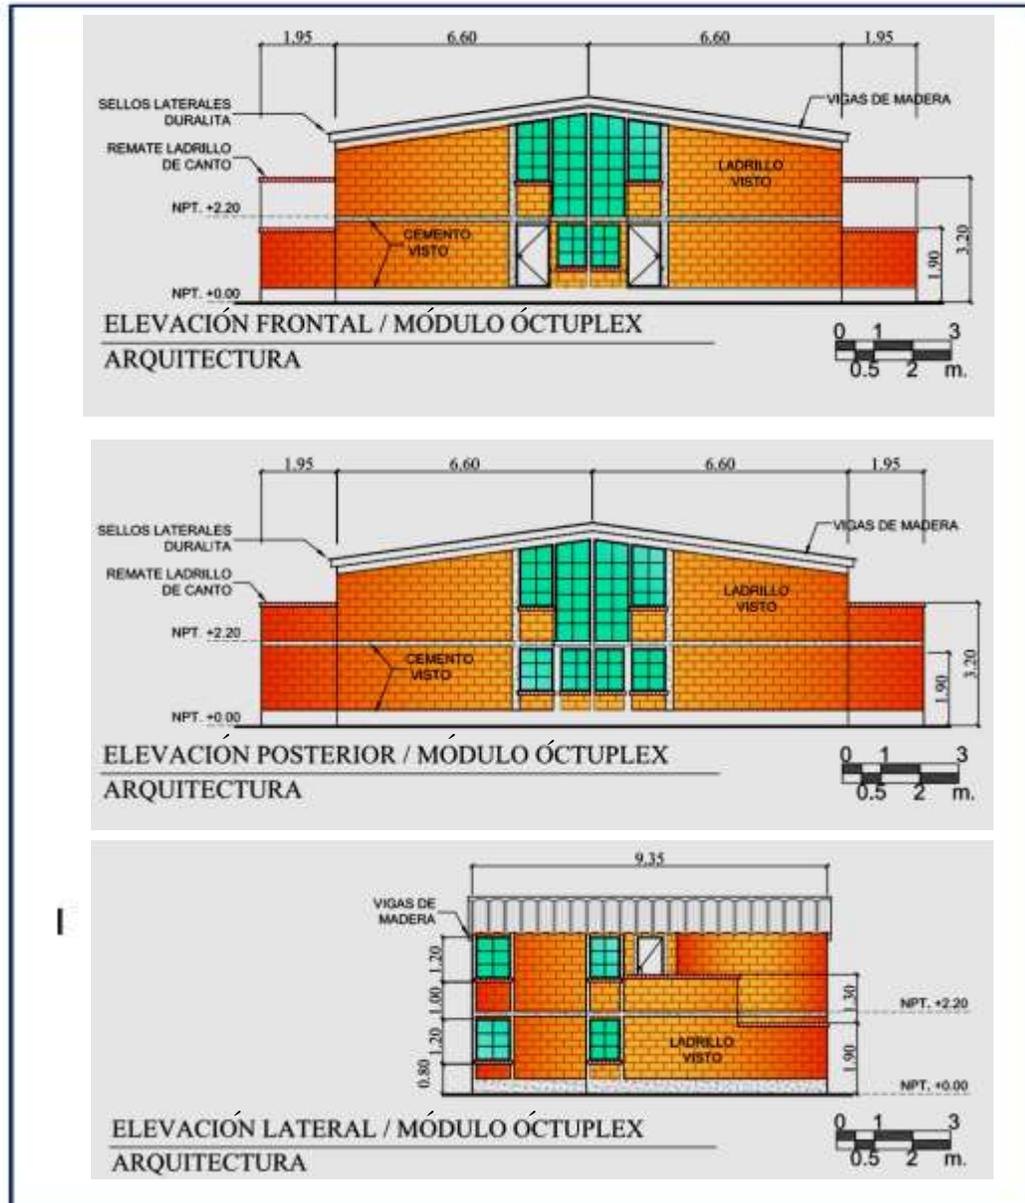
Plano de elevaciones frontal y lateral, módulo óctuplex
